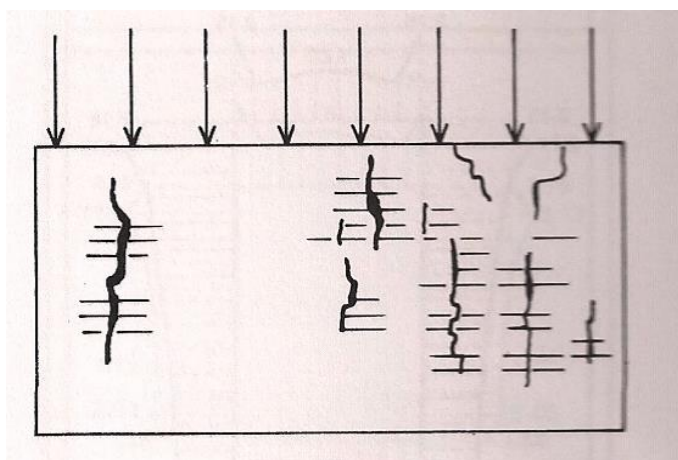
Fissura vertical em alvenaria causada por sobrecarga.
